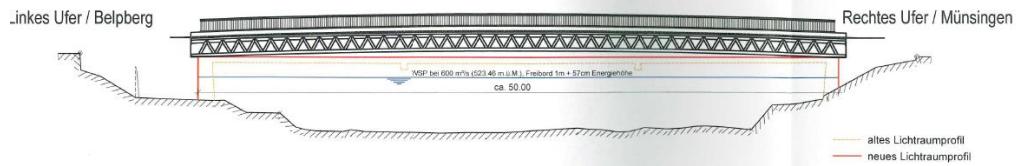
Variante Rohrfachwerkbrücke mit Betonplatte
